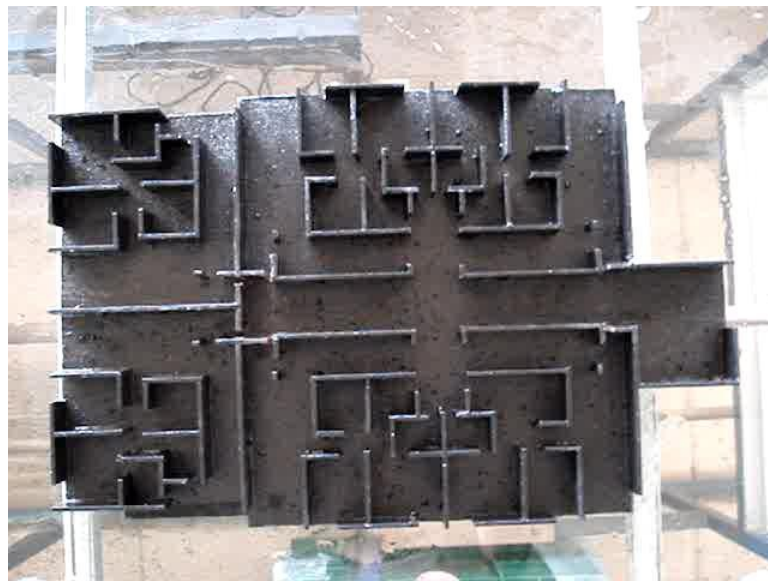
Maquete modelo do pavimento tipo da edificação em estudo.
